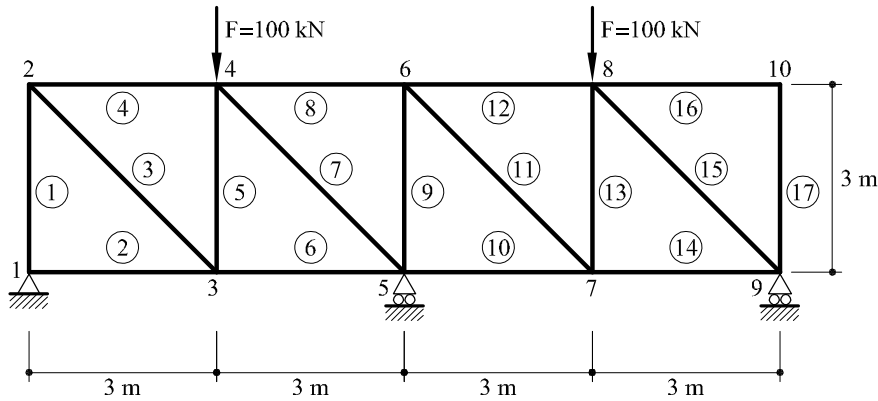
Estructura articulada correspondiente al problema 8.11
